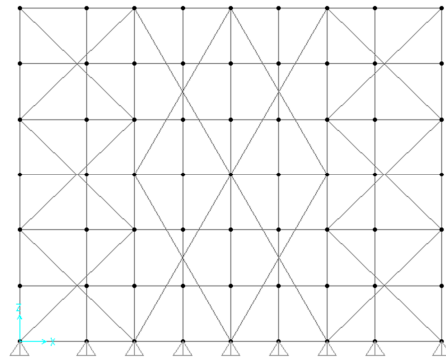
Configuração dos Planos de Contraventamento Vertical Com Elementos de Contraventamento Grandes
